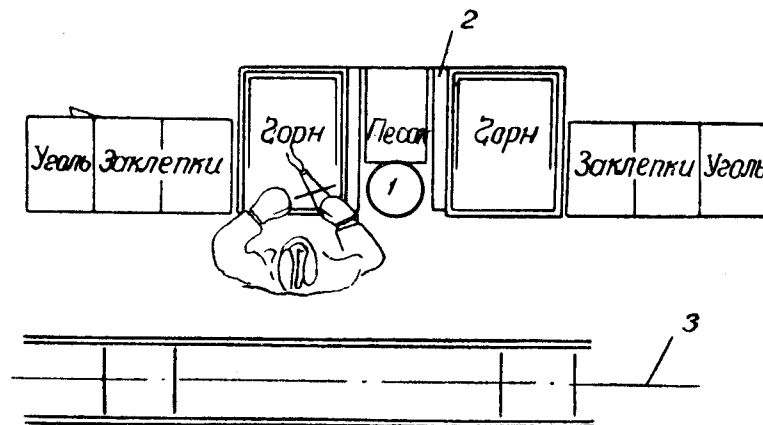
Рабочее место нагревальщика с двумя двосными горнами: 1 — ведро с водой; 2 — полка для инструмента; 3 — ось клепаемой конструкции
